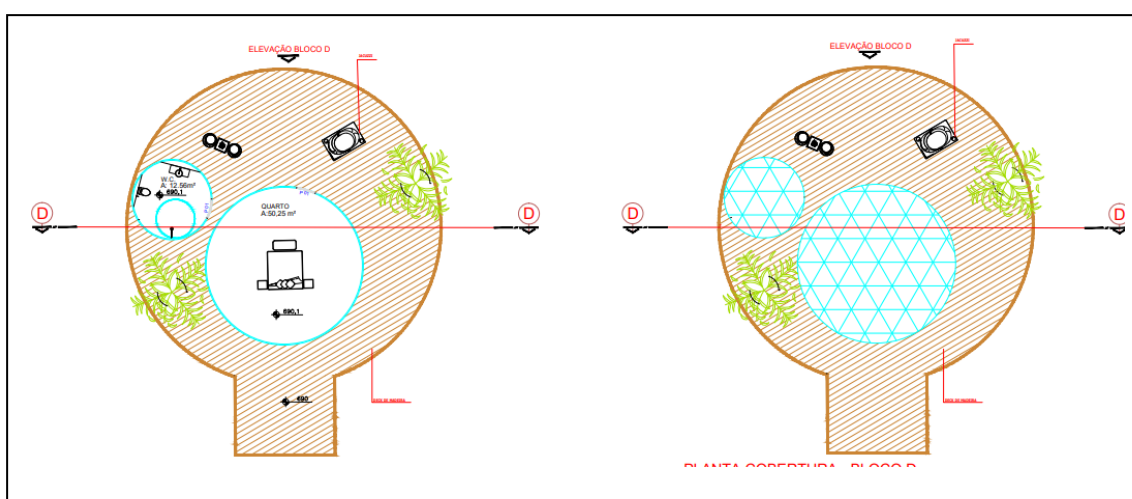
Planta baixa e planta de cobertura da tipologia *Domo Geodésico
